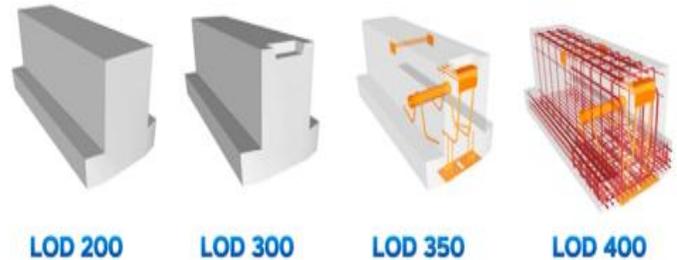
LOD – Estructuras (Viga de concreto armado).
